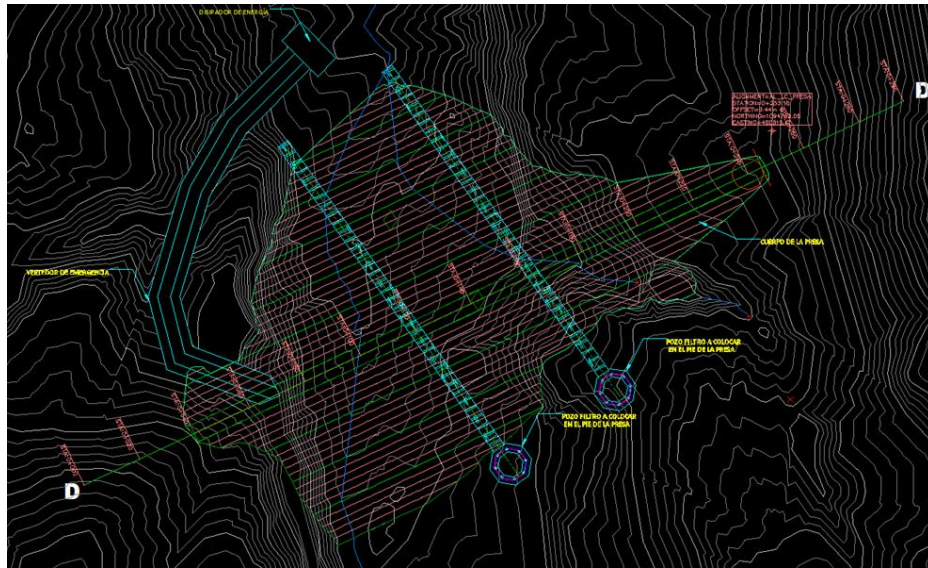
VISTA EN PLANTA ESTRUCTURA ALMACENAMIENTO TEMPORAL.
